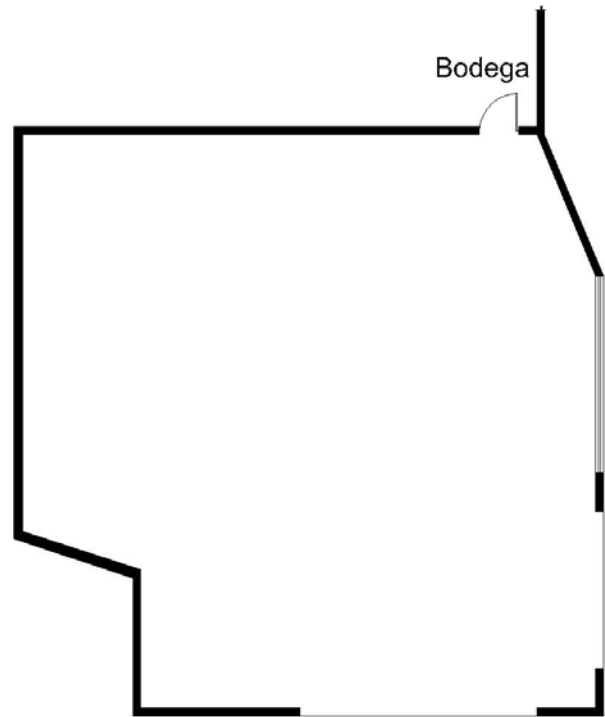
Plano en planta de Miniso sucursal Plaza San Luis, de autoría propia (2023).
